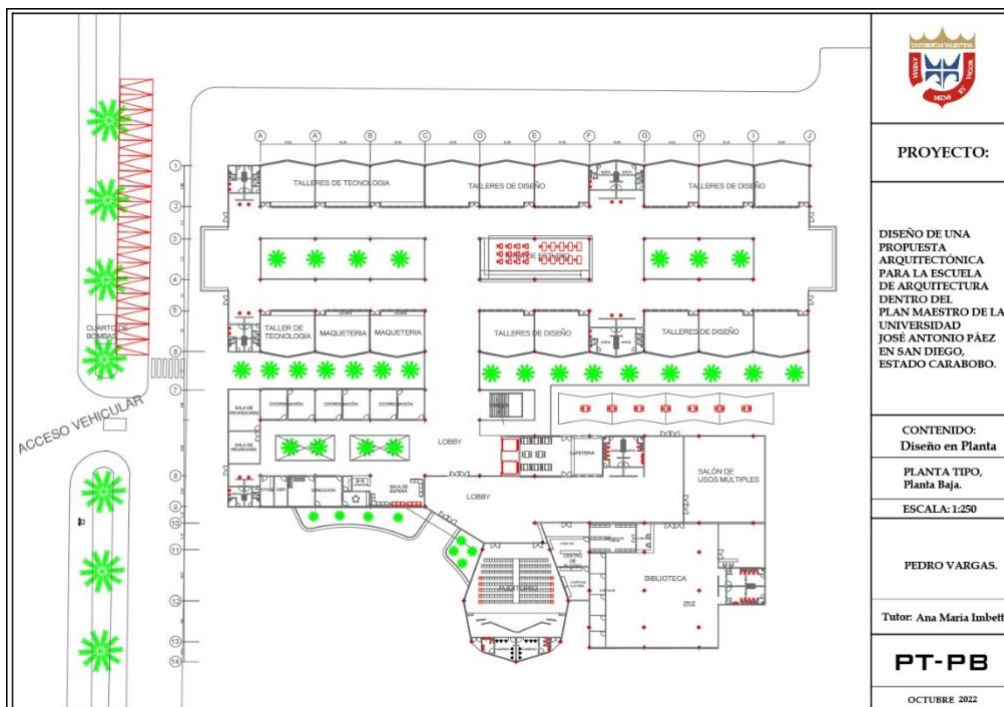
Plano de diseño en vista de planta para Planta Baja.
